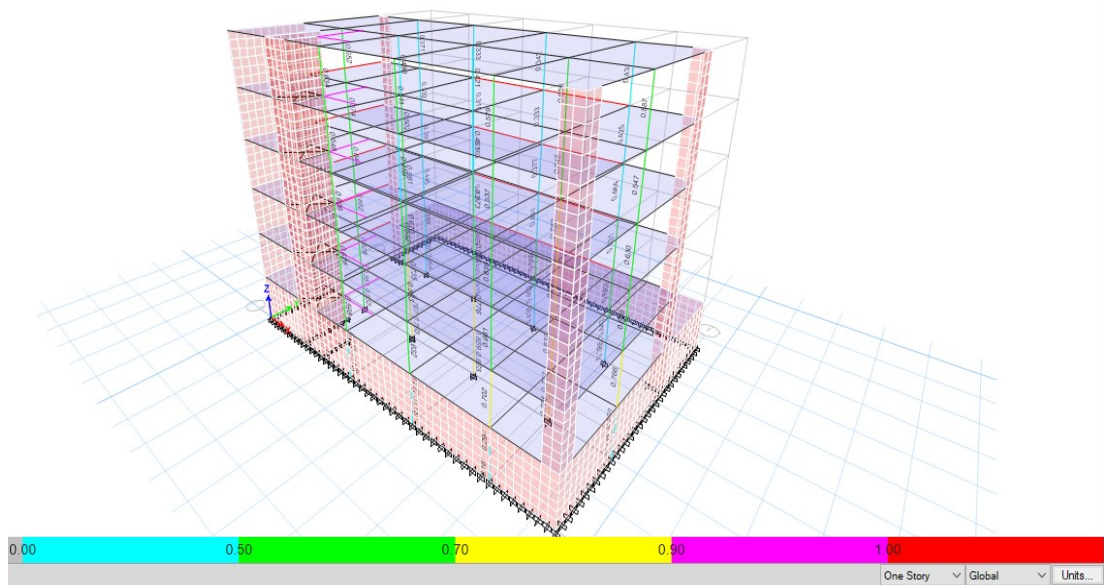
A: Vista 3D del modelo y demanda - capacidad de las columnas. Fuente: elaboración propia.
